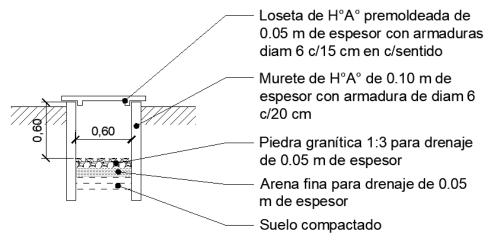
Perfil de un canal para cables Fuente: BRUNO (2011)
